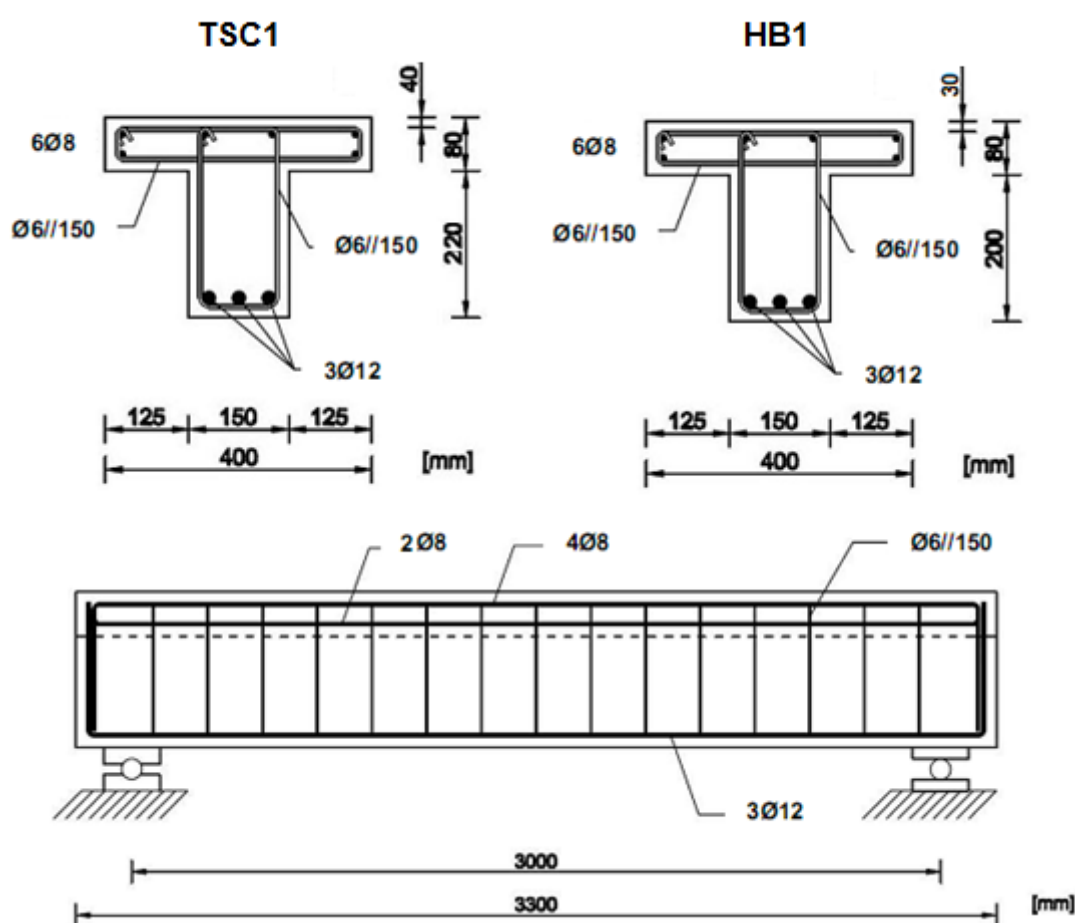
Pormenorização das vigas tipo TSC1 e HB1 (retirado de [15])
